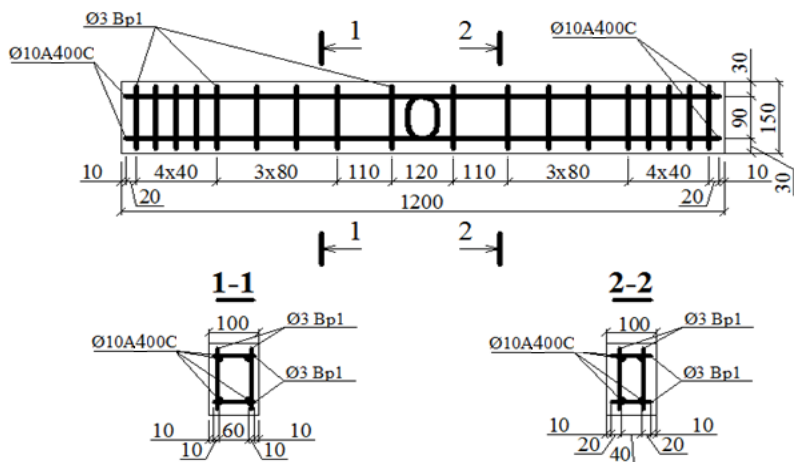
Схема армирования опытных железобетонных балок Б3 – Б7
